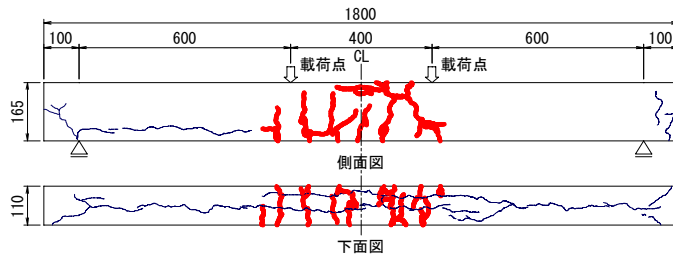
ひび割れ図 (電食後: 細線, 載荷後: 太線)
